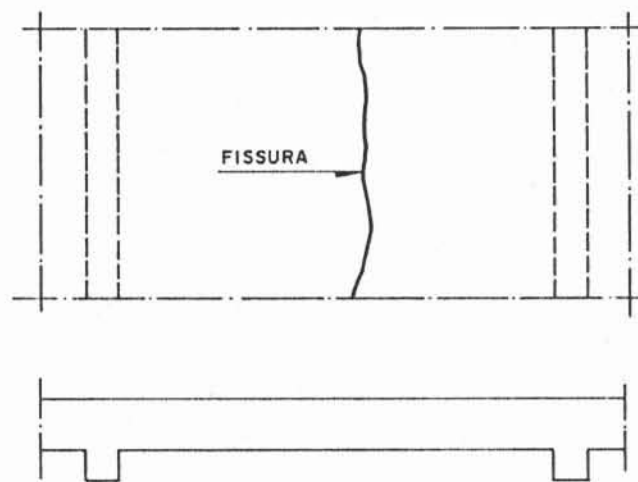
Fissura em laje causada por retração hidráulica (MONTROYA<sup>55</sup>).
